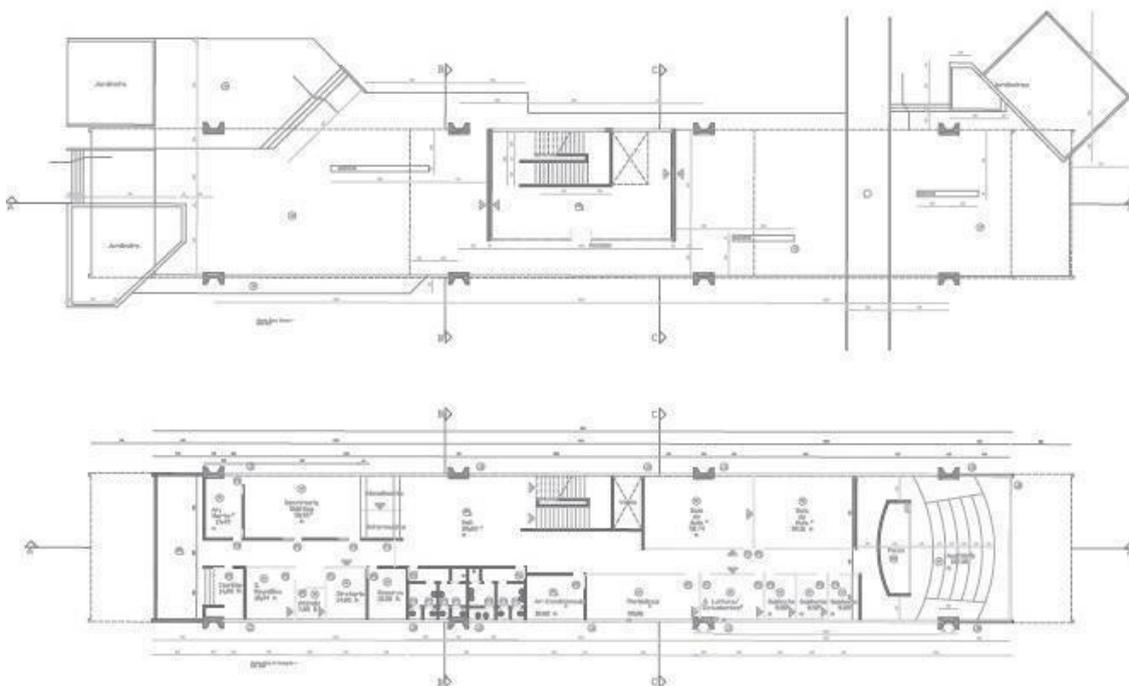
Plantas Térreo e 1º pavimento do NPD/UFC Arq.Nearco Araujo.
